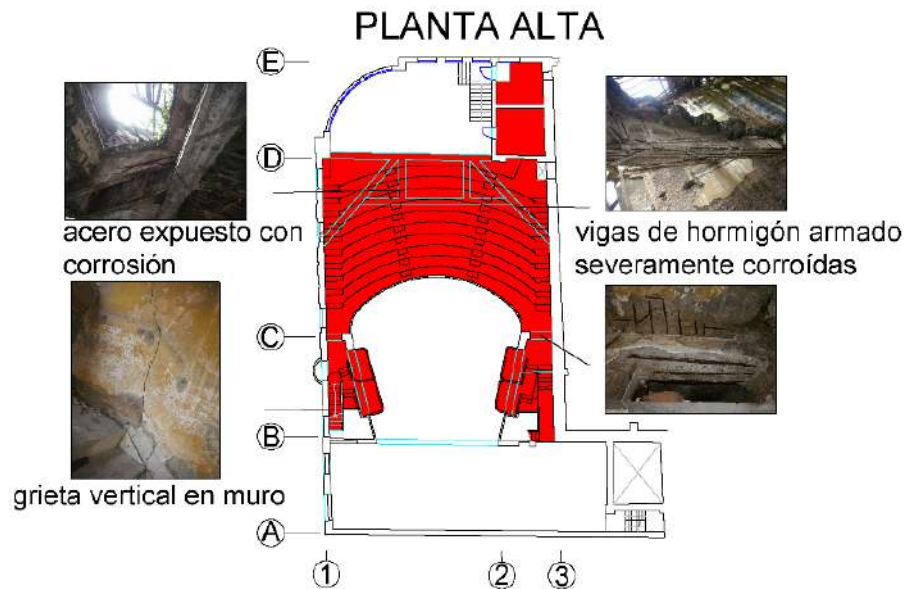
Planta alta del teatro en el sistema de soporte de la platea y los balcones, con grietas verticales en los muros y pérdida total del recubrimiento con refuerzos de acero corroídos.
